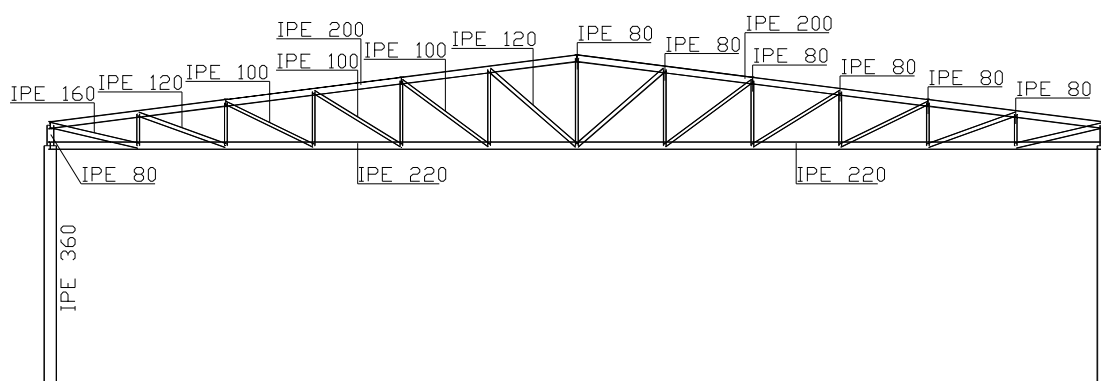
Pórtico com pilar de alma cheia, viga em treliça, vão de 30.00m, pilar em perfil com secção transversal IPE.
